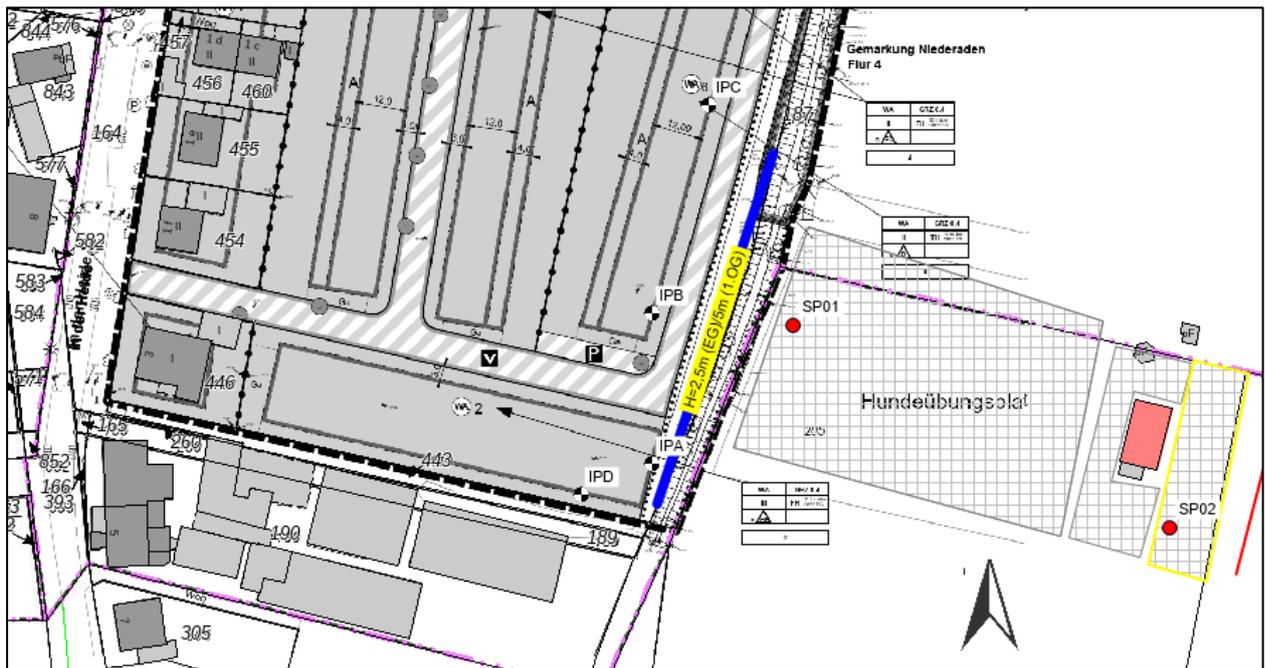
Darstellung mit Lage der Lärmschutzwand, Quelle Bebauungsplanentwurf Stadt Lünen
